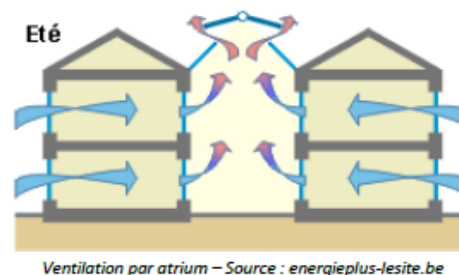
Schéma d'une ventilation d'une construction par atrium
